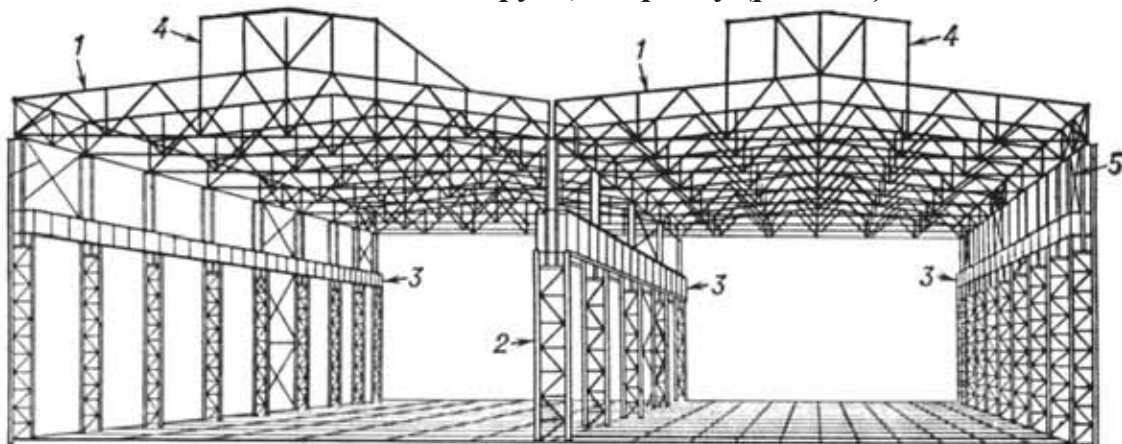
Промислові будівлі із залізобетонним каркасом:
